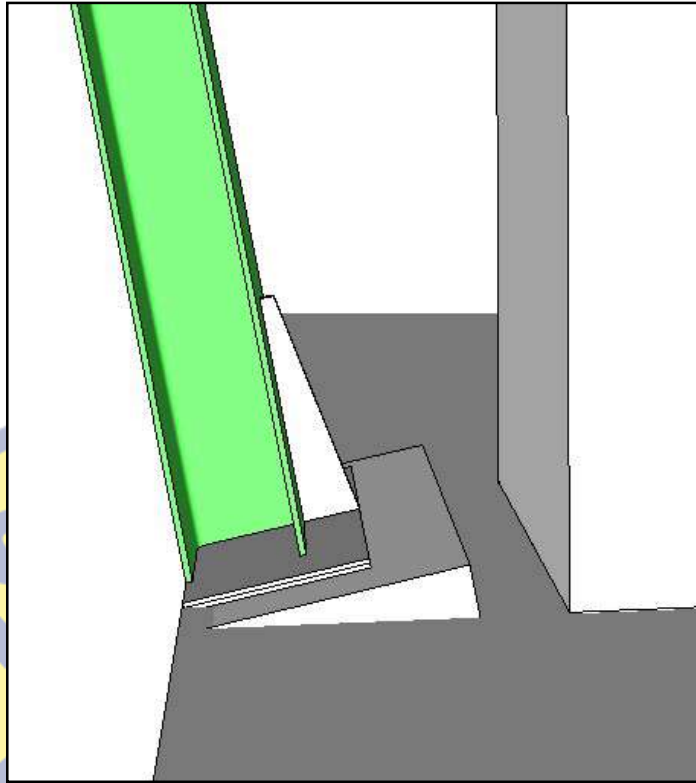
Potongan *for construction* kolom miring gedung P1 & P2
